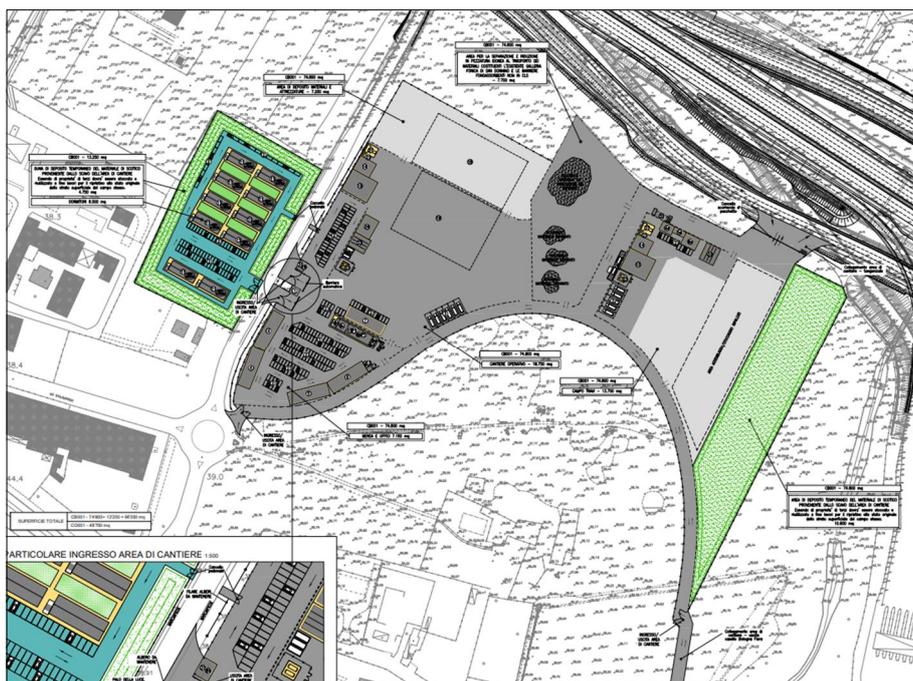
Layout dell'area di cantiere CB01 (stralcio da SIC0300)
